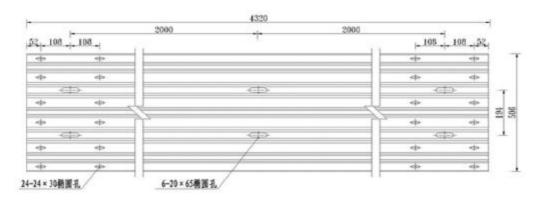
三波形梁板螺孔平面图(尺寸单位: mm)
